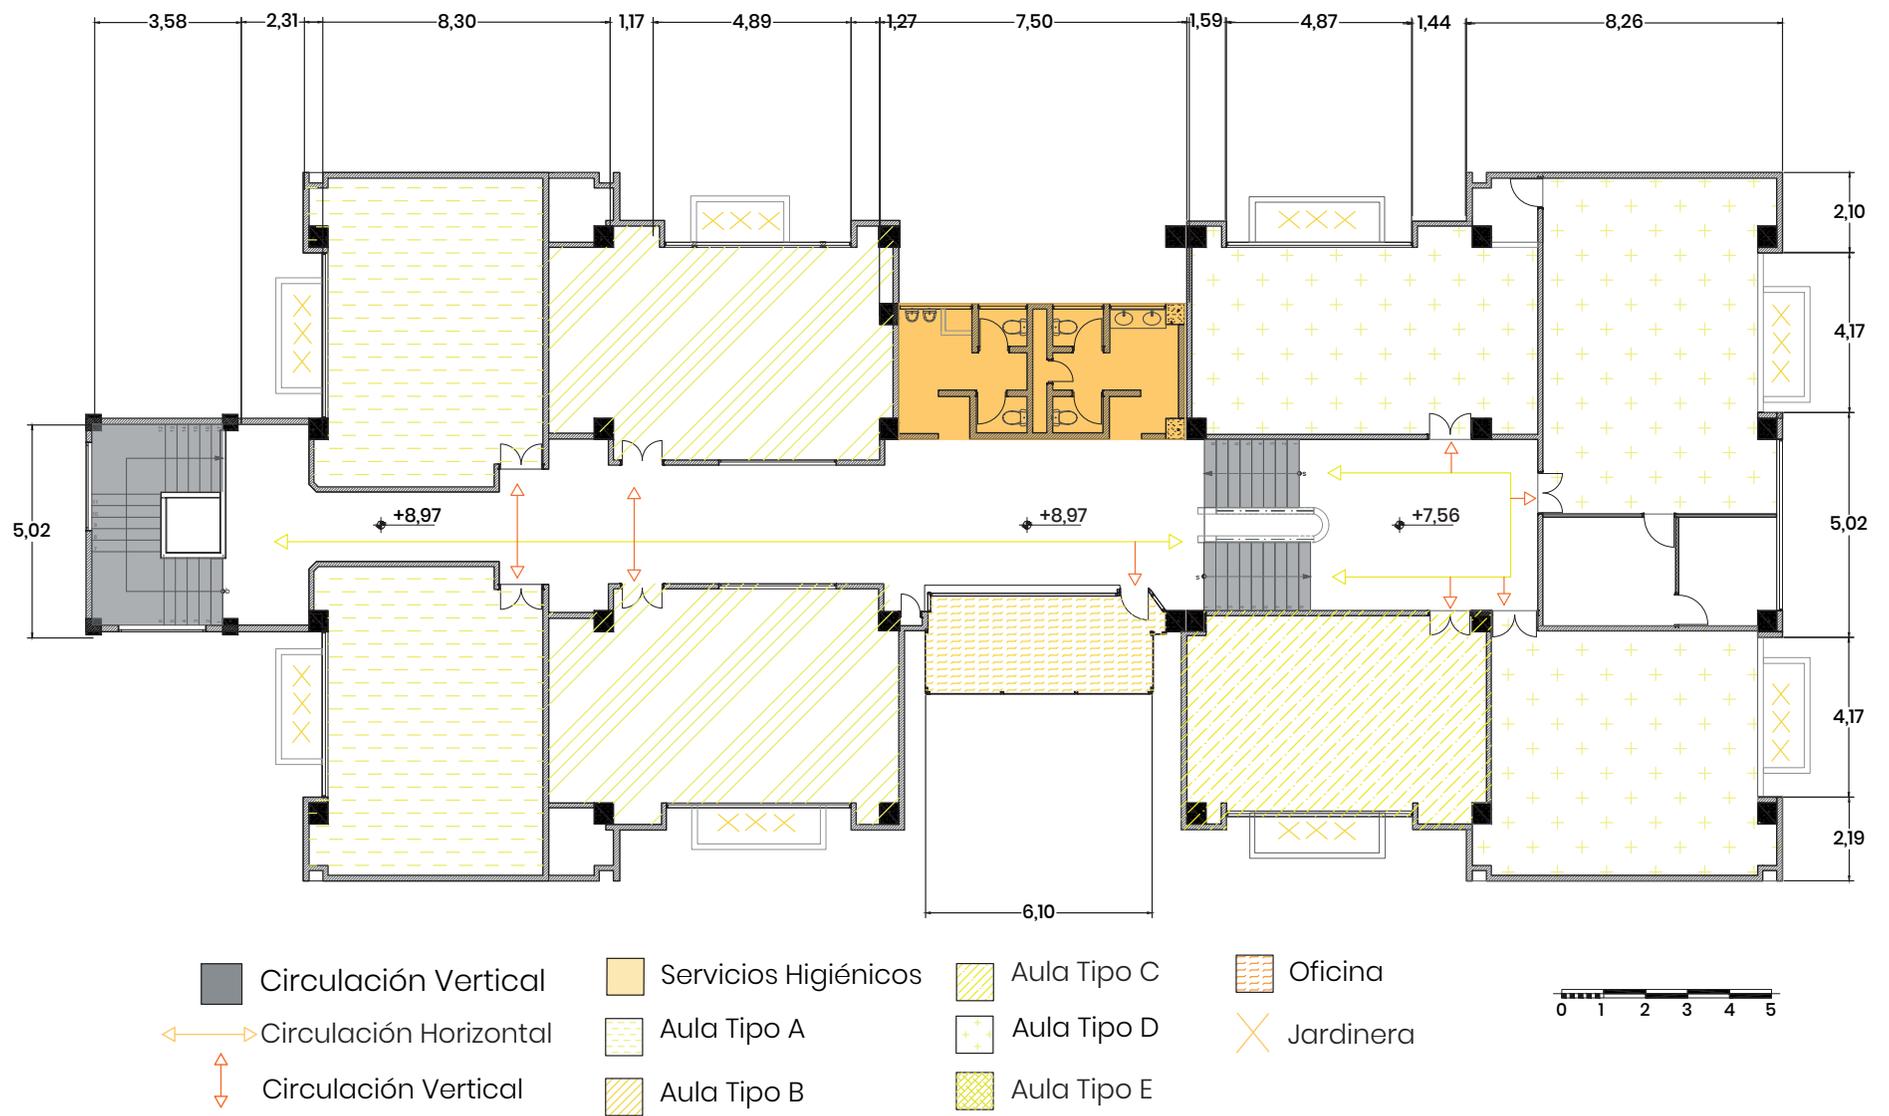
Zonificación Quinta y Sexta Planta Alta Bloque "E1".
